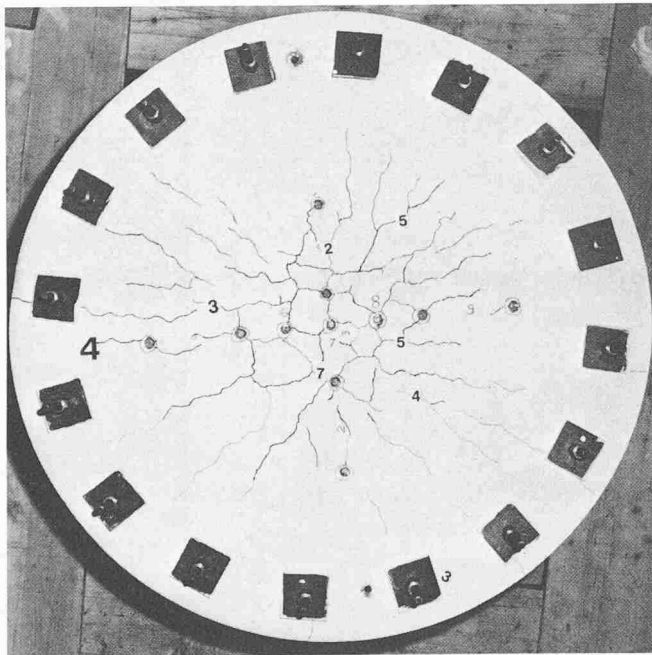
Rissbild unter Nutzlast ($P = 138 \text{ kN}$) bei Leichtbeton. Rissbreiten in $1/100 \text{ mm}$
